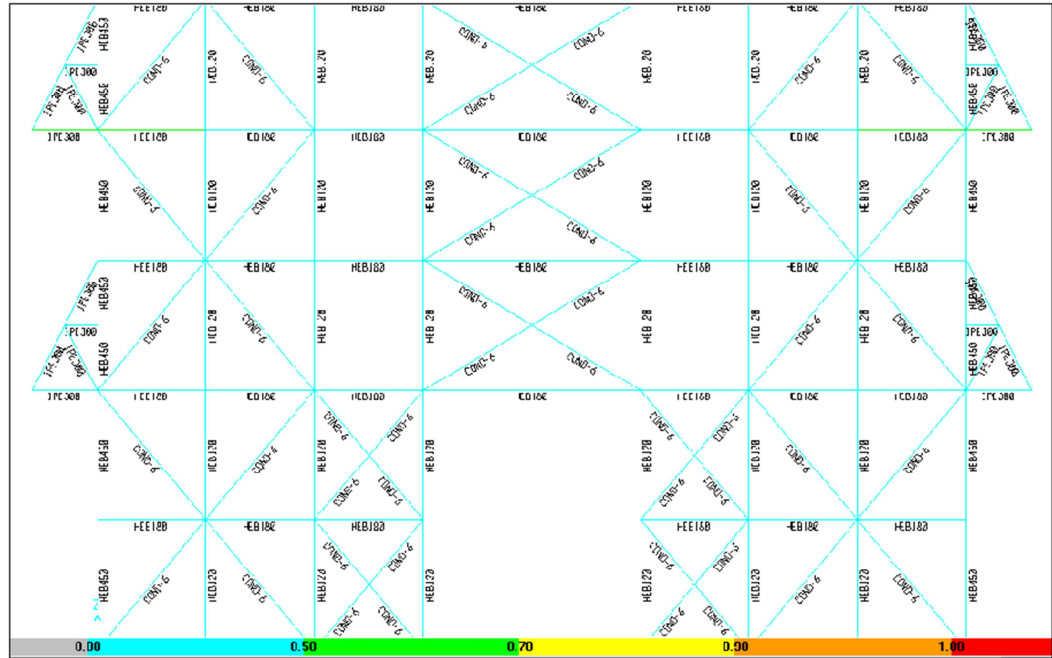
Columnas secundarias, vigas secundarias y arriostramiento lateral cotejados.
